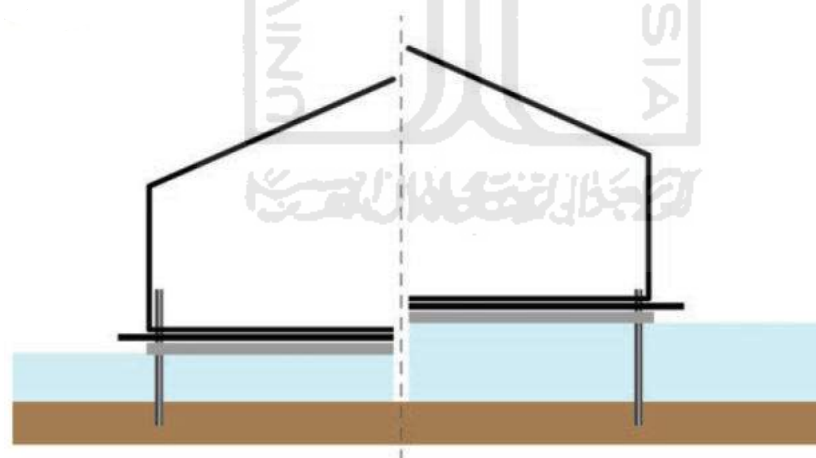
Orientasi bangunan (Sumber: Building Design+Construction, 2017)
